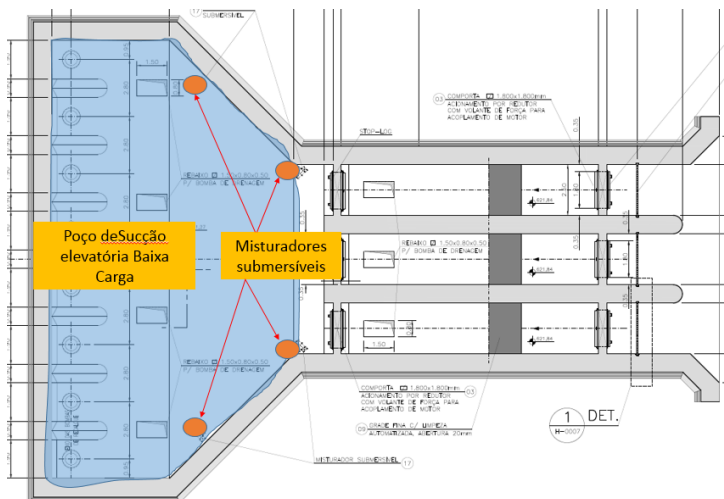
Poço de sucção da Estação Elevatória de Baixa Carga
